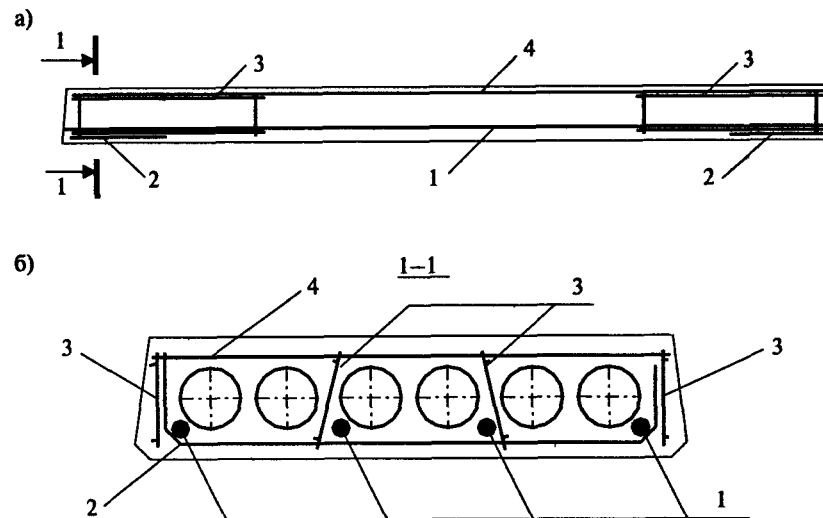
Армирование предварительно напряженной пустотной плиты перекрытия: а) продольный разрез плиты; б) поперечный разрез плиты; 1 — предварительно напряженная арматура; 2 — сетка, окружающая предварительно напряженную арматуру на участках передачи напряжения; 3 — каркасы; 4 — монтажная сетка
